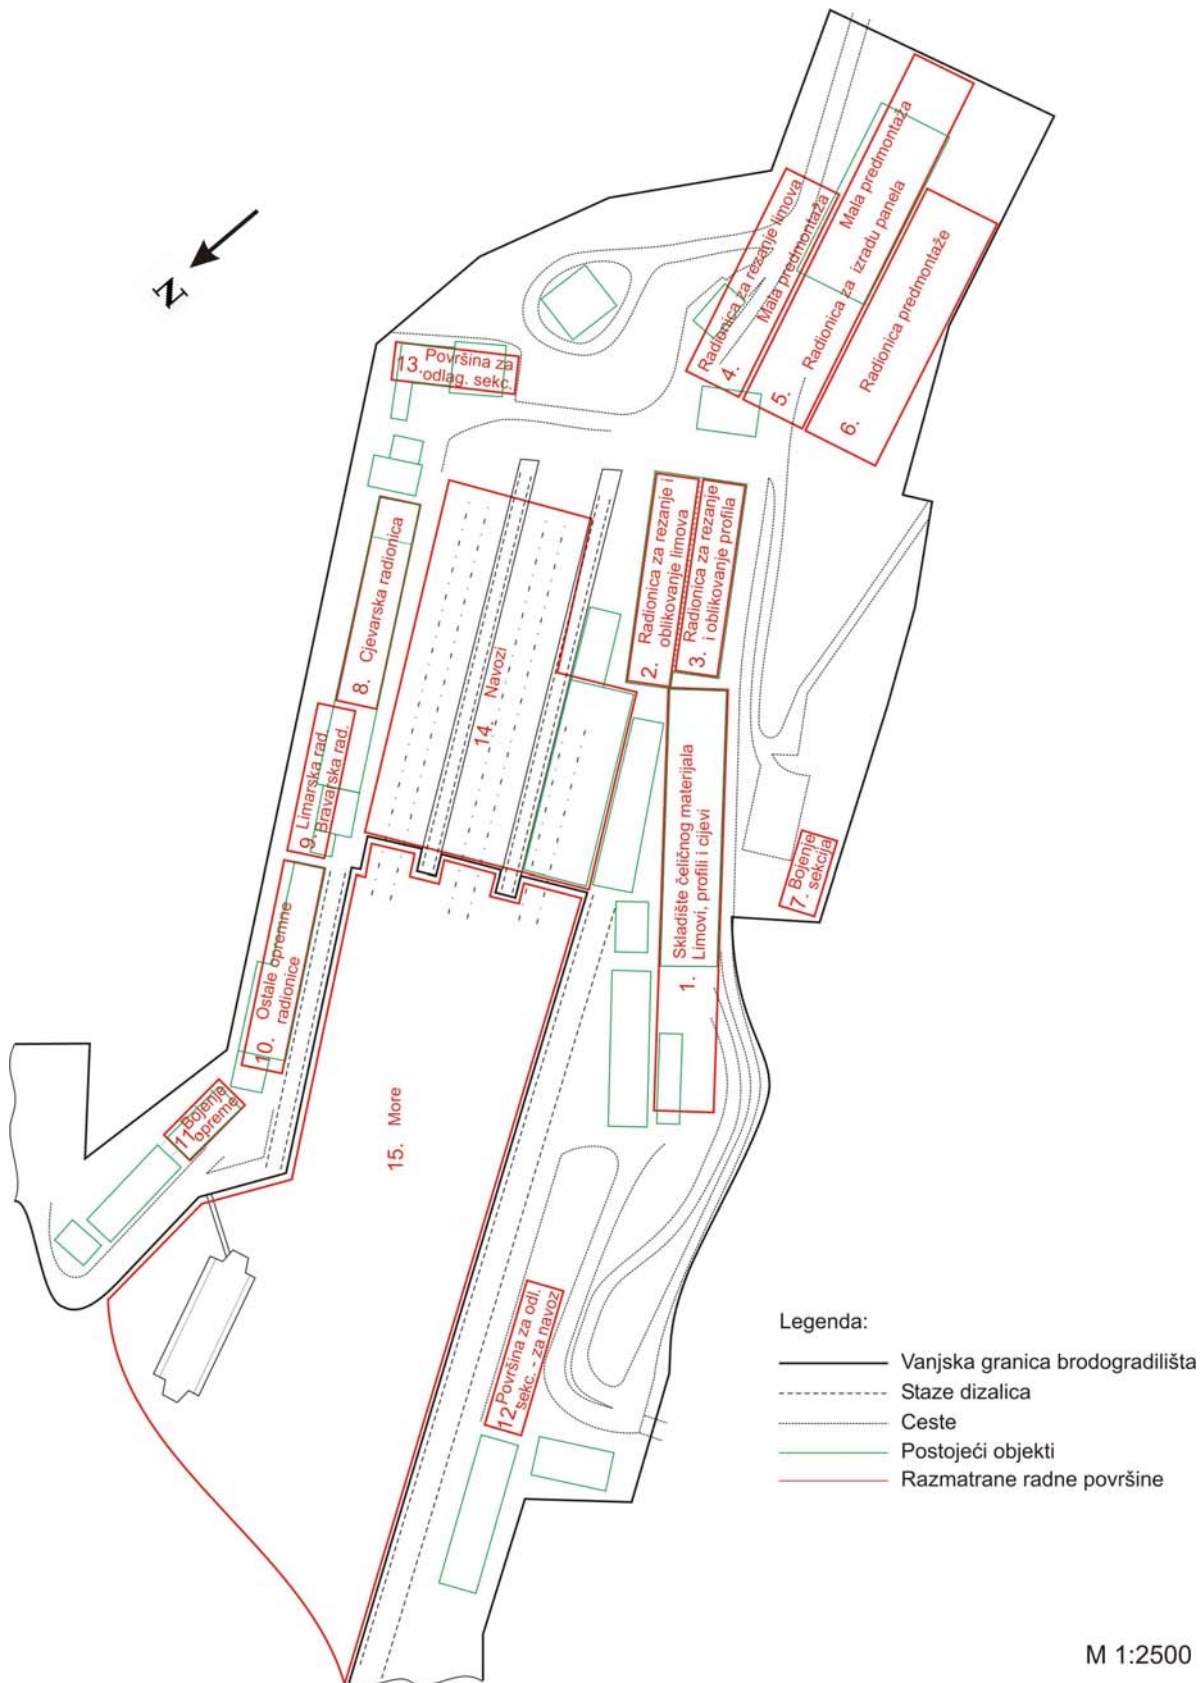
Prikaz varijante 16 generirane SLP metodom
